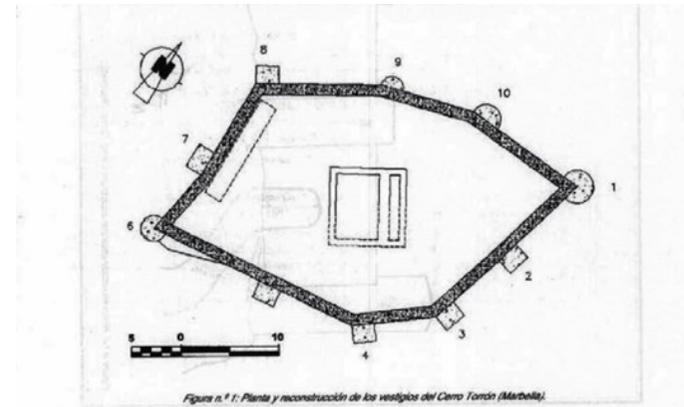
Planta y reconstrucción de los vestigios del Cerro Torrón (Marbella).
